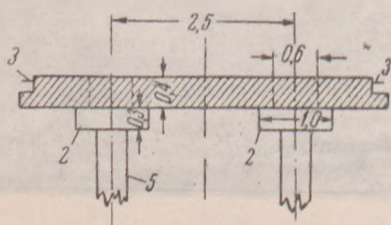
в. 2 — жел.-бет. площадки на головках свай; 3 — выпуски арматуры из звеньев плиты причала; 5 — жел.-бет. сваи
